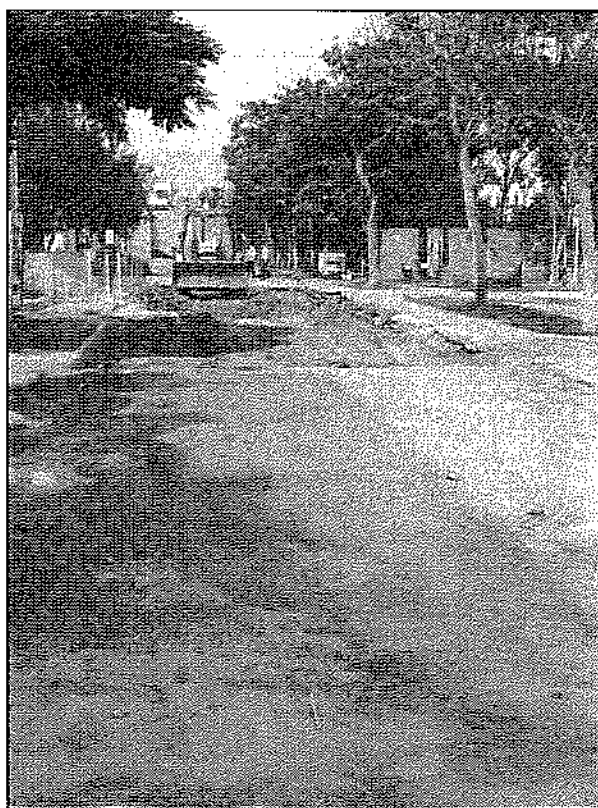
Demolición de pistas existente y La muestra de la sub rasante para el ensayo de Proctor
